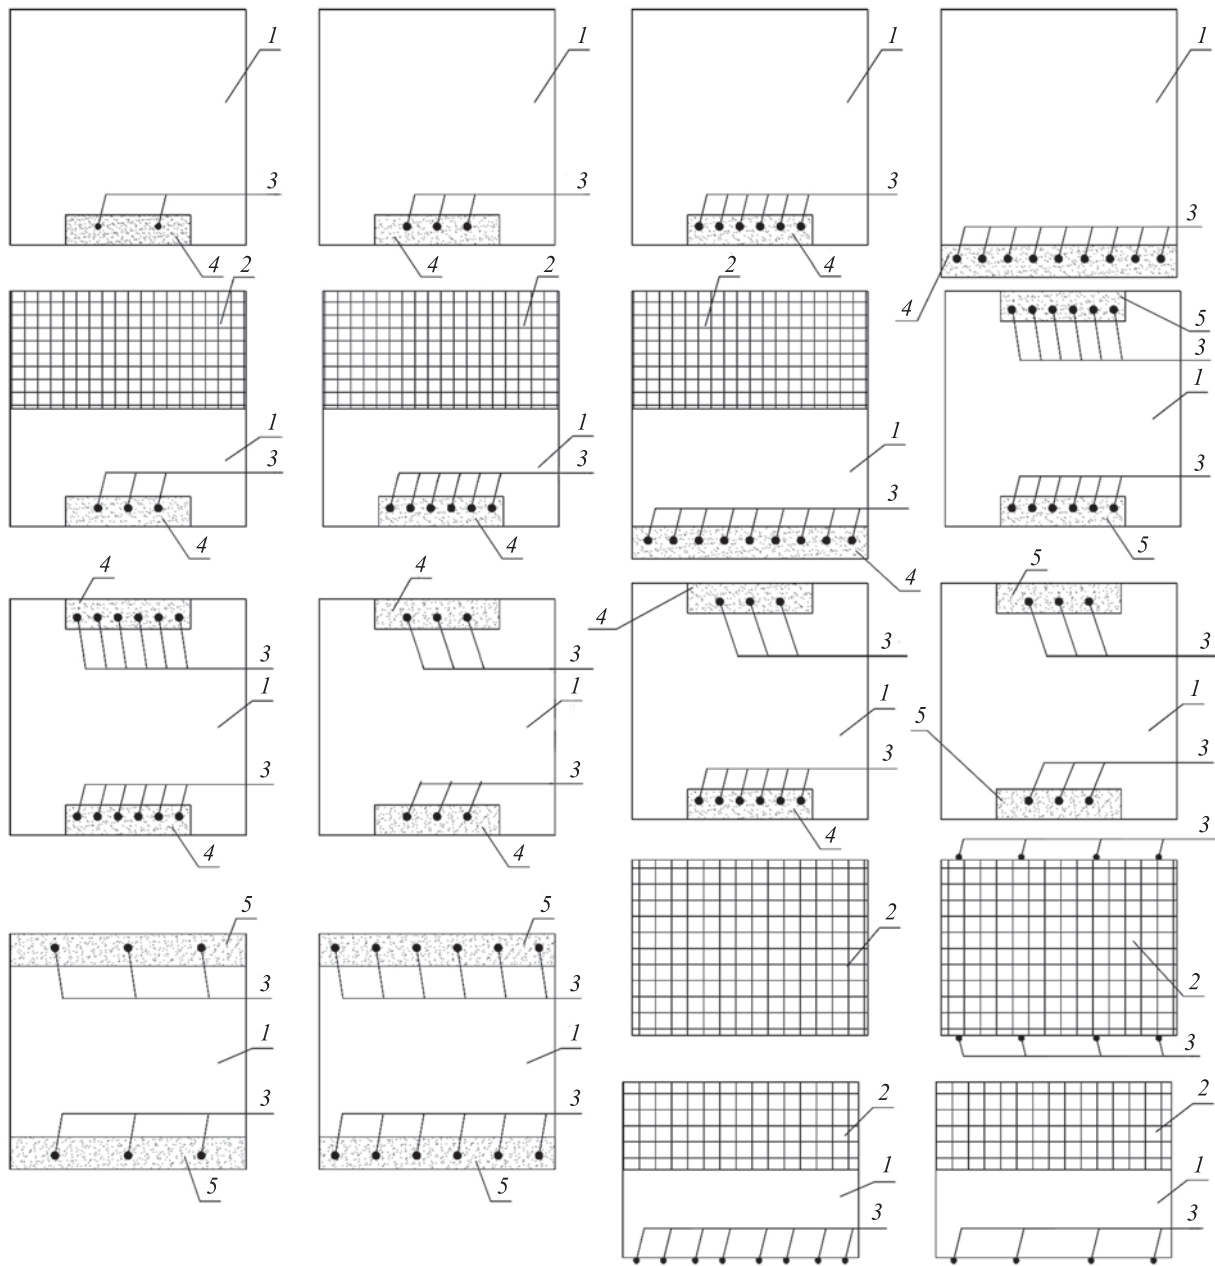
Схемы армирования опытных образцов, опыты В.А. Камейко: 1 — каменная кладка; 2 — кладка с поперечным армированием; 3 — продольная арматура; 4 — раствор; 5 — бетон [20, 21]
